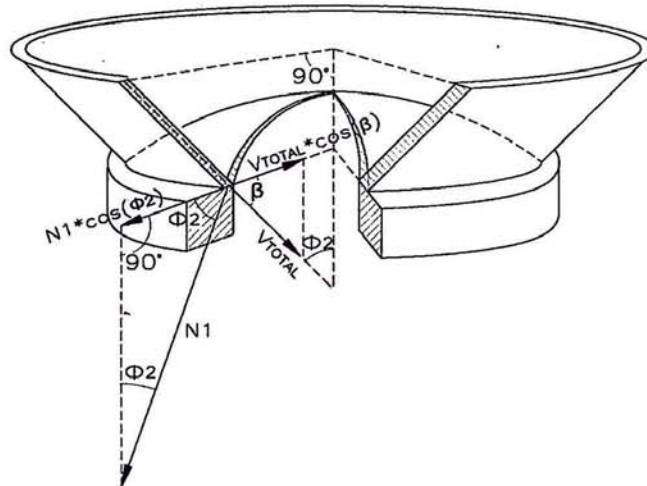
Esfuerzos sobre la viga de apoyo
